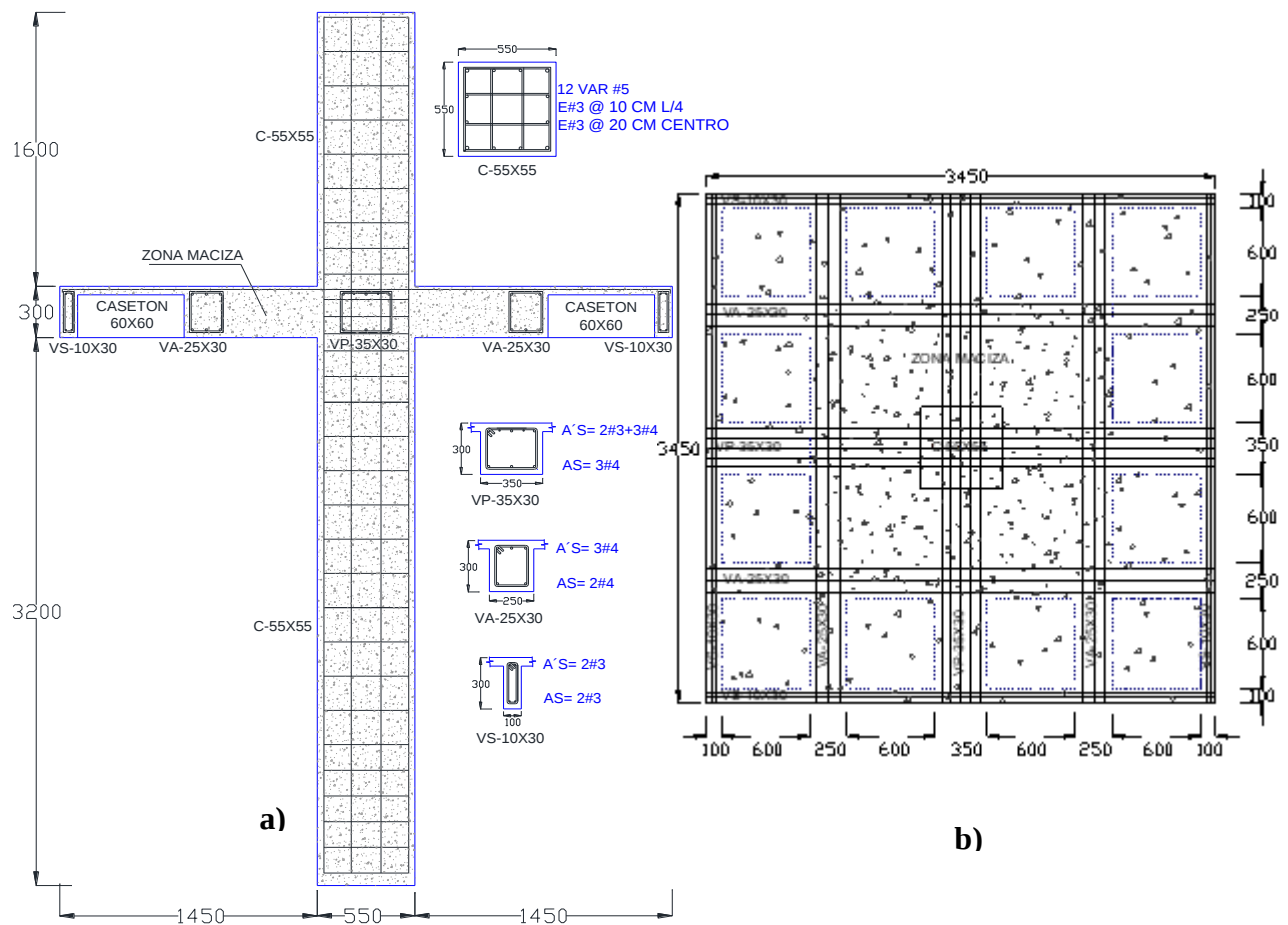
Detalles de armado de los elementos estructurales, a) vista lateral y b) vista en planta
